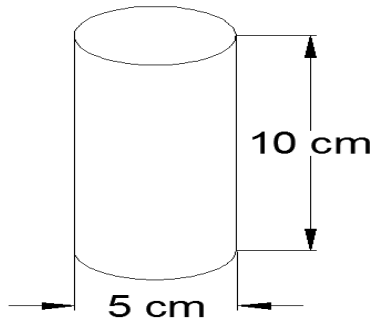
22 Benda uji silinder beton yang akan dites tekan
